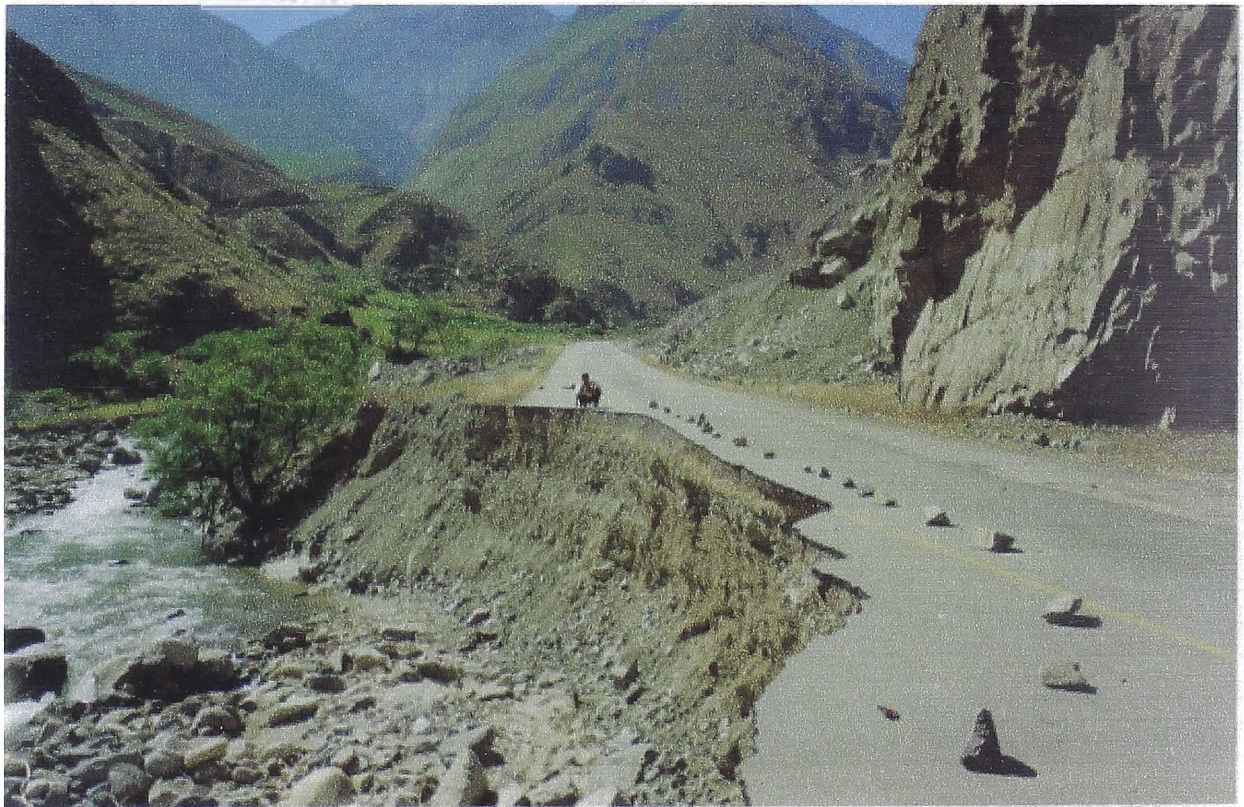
Colapso de otro tramo de la Carretera Lima - Canta.
